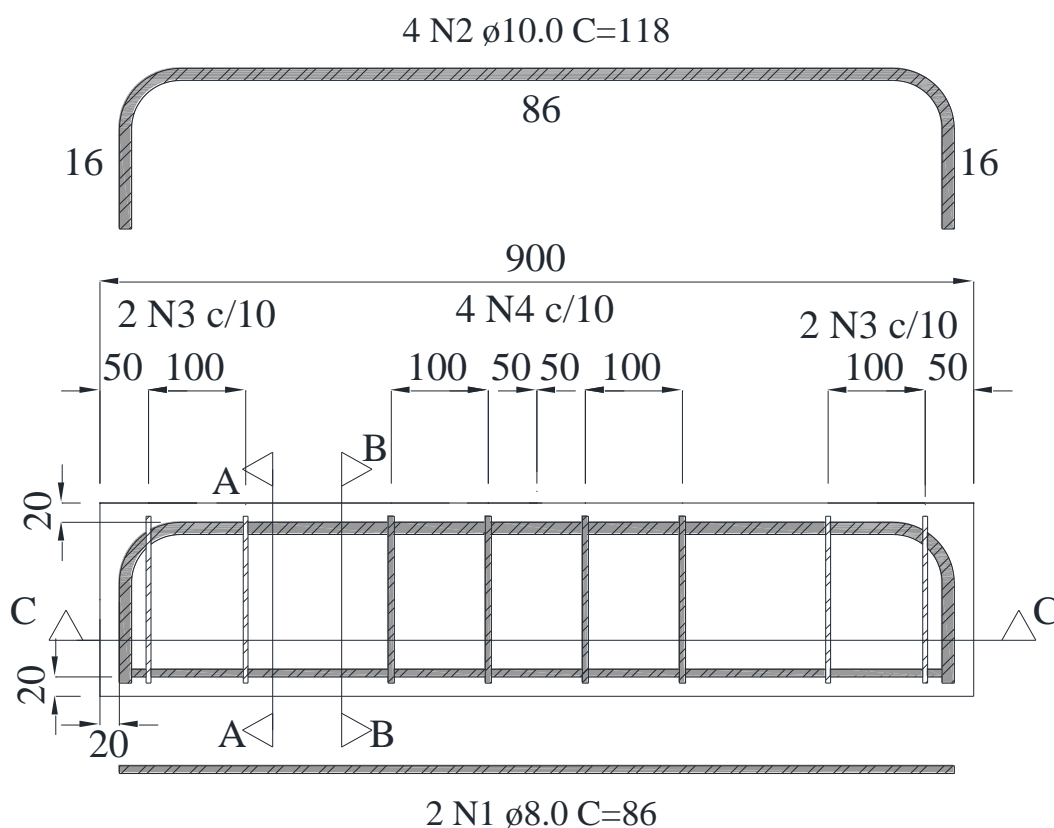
Detalhamento longitudinal do espécime da primeira etapa de ensaios
